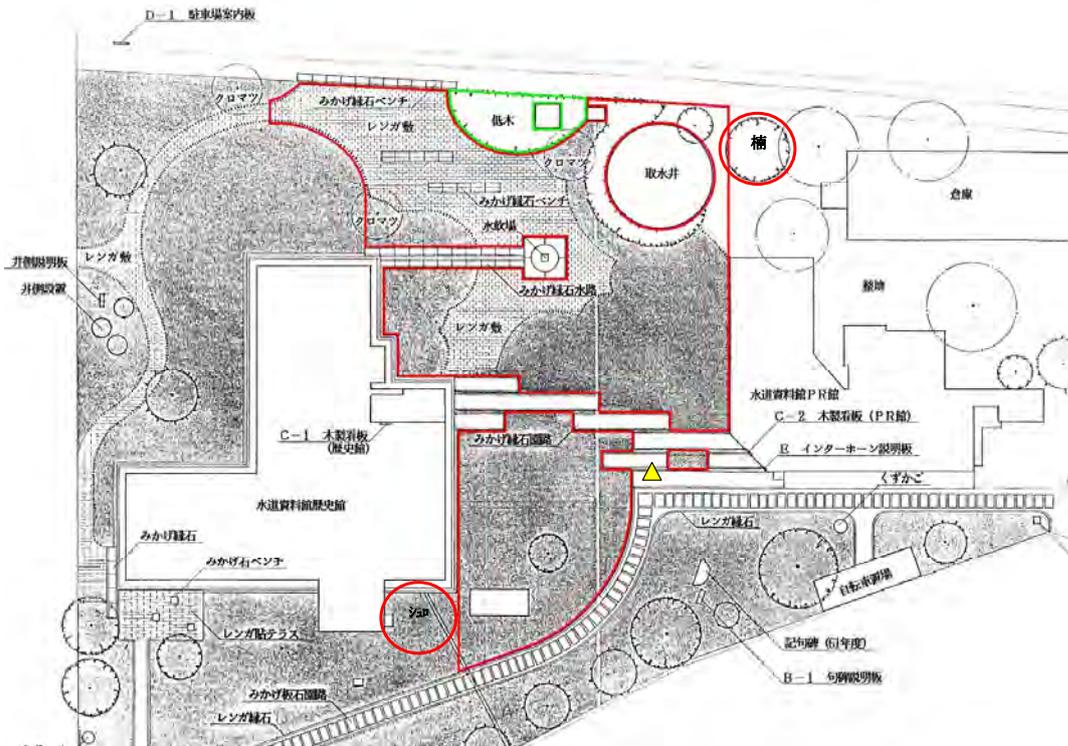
平成 21 年度外構改修工事 全体計画平面図
